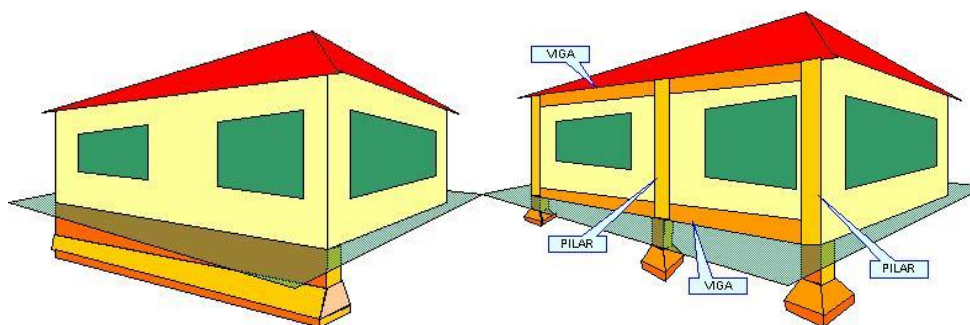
Sapata Corrida e Sapata Simples (Watanabe, 2008)
